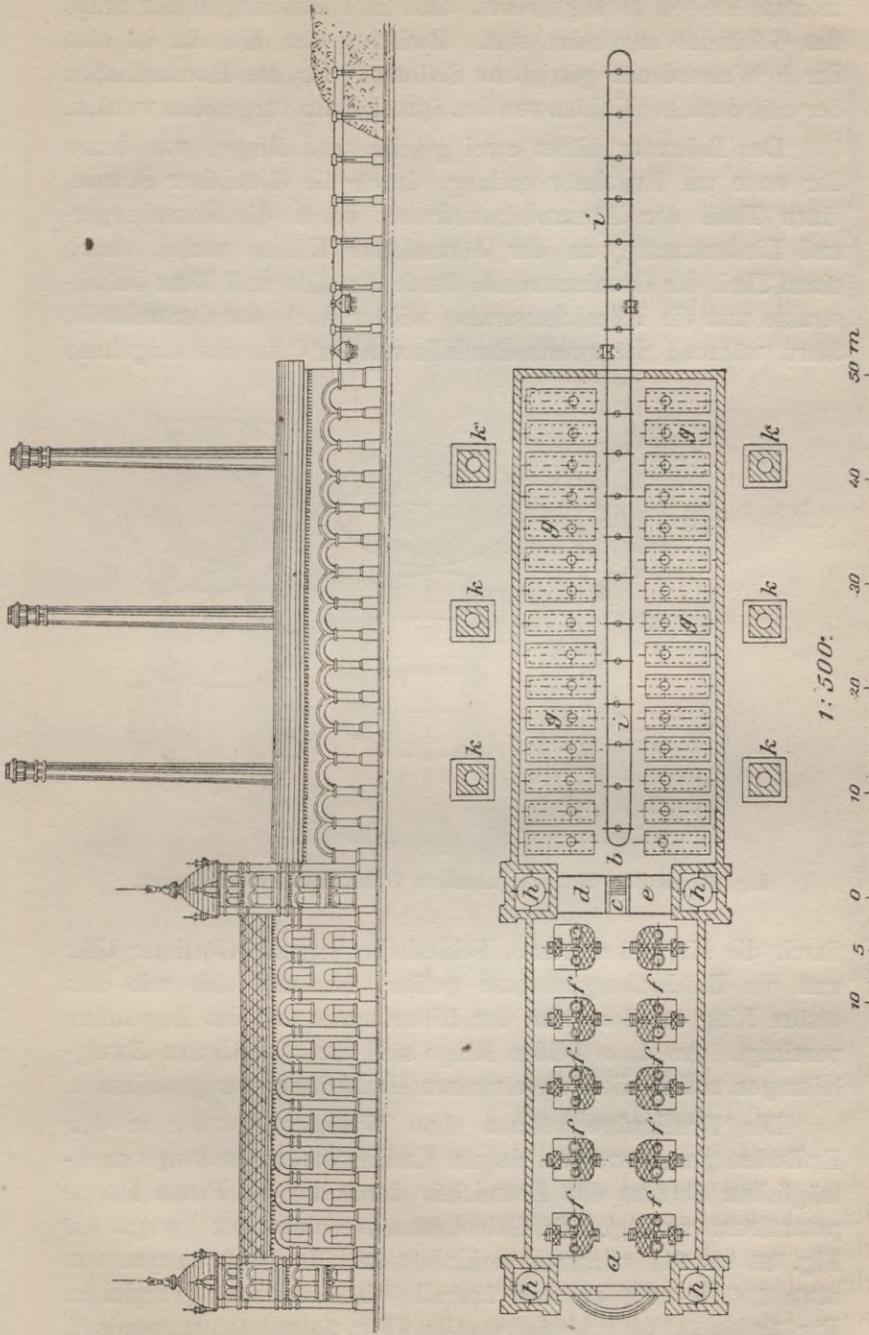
und 45. Entwurf Hoppe: Ansicht und Grundriss der Centralen.
